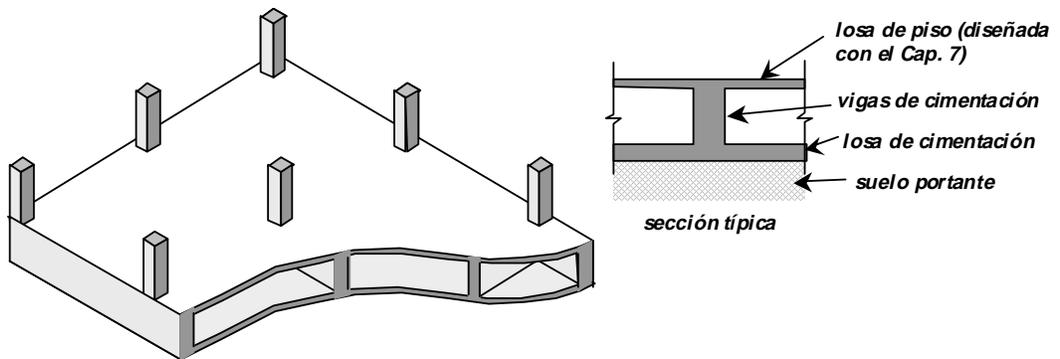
Losa de cimentación con vigas sobre ella.
